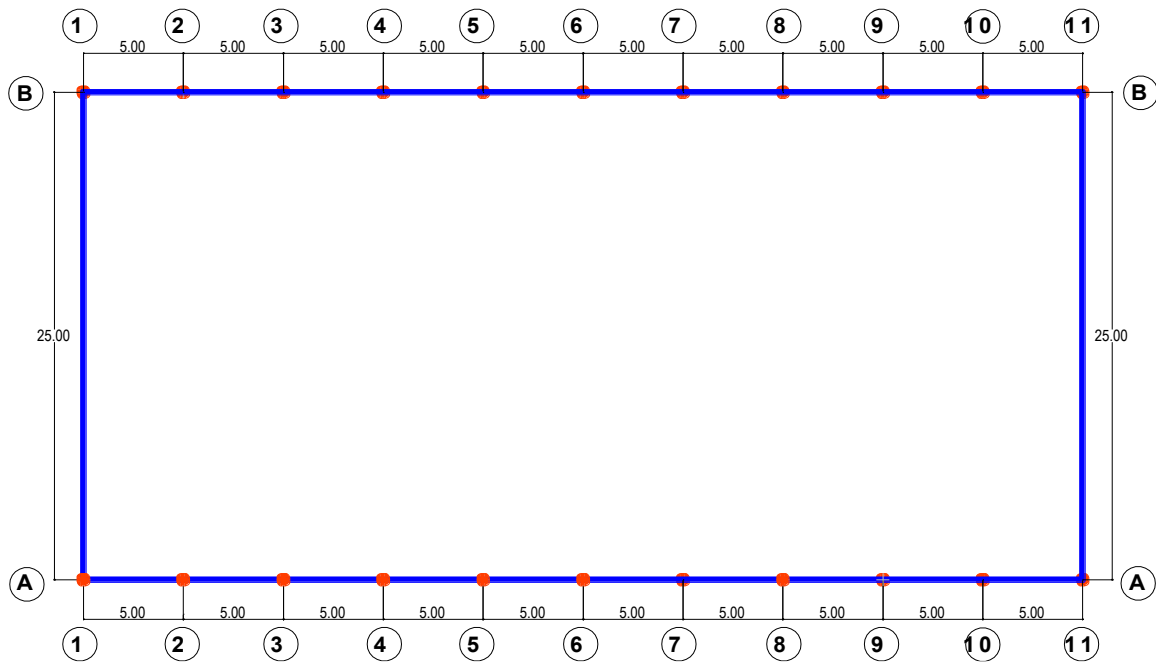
Distribución de las zapatas: Fuente elaboración propia
